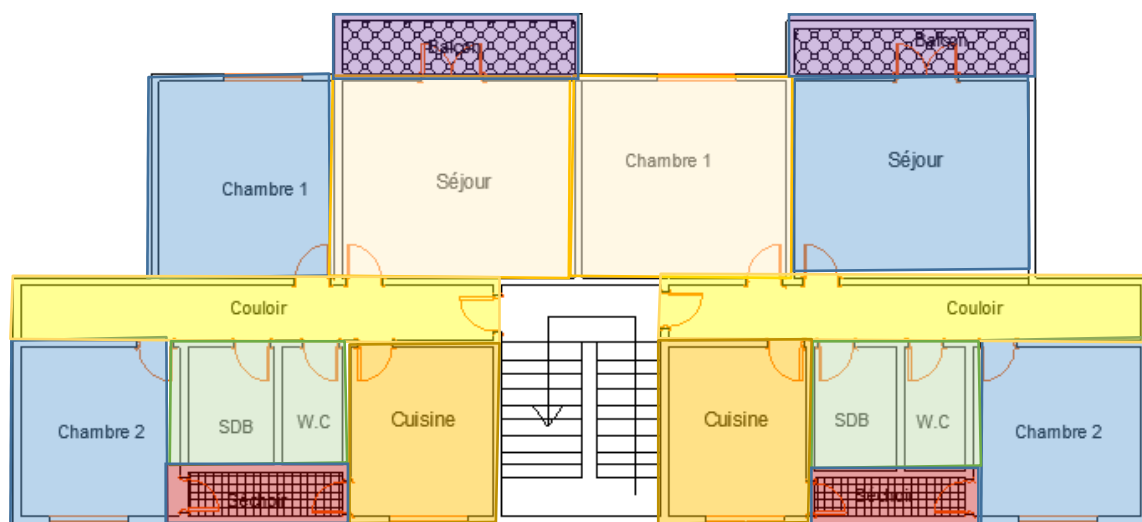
plan d'un bâtiment type F3 Les 600 logs Iheddaden Bejaïa, source : auteur ; 2024
